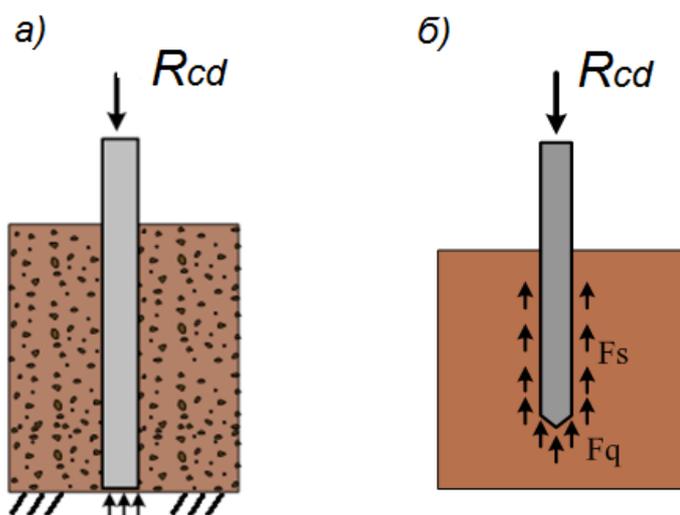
Расчетные схемы к определению несущей способности свай: а) – для свай-стойки; б) – для свай, заземленной в грунте
